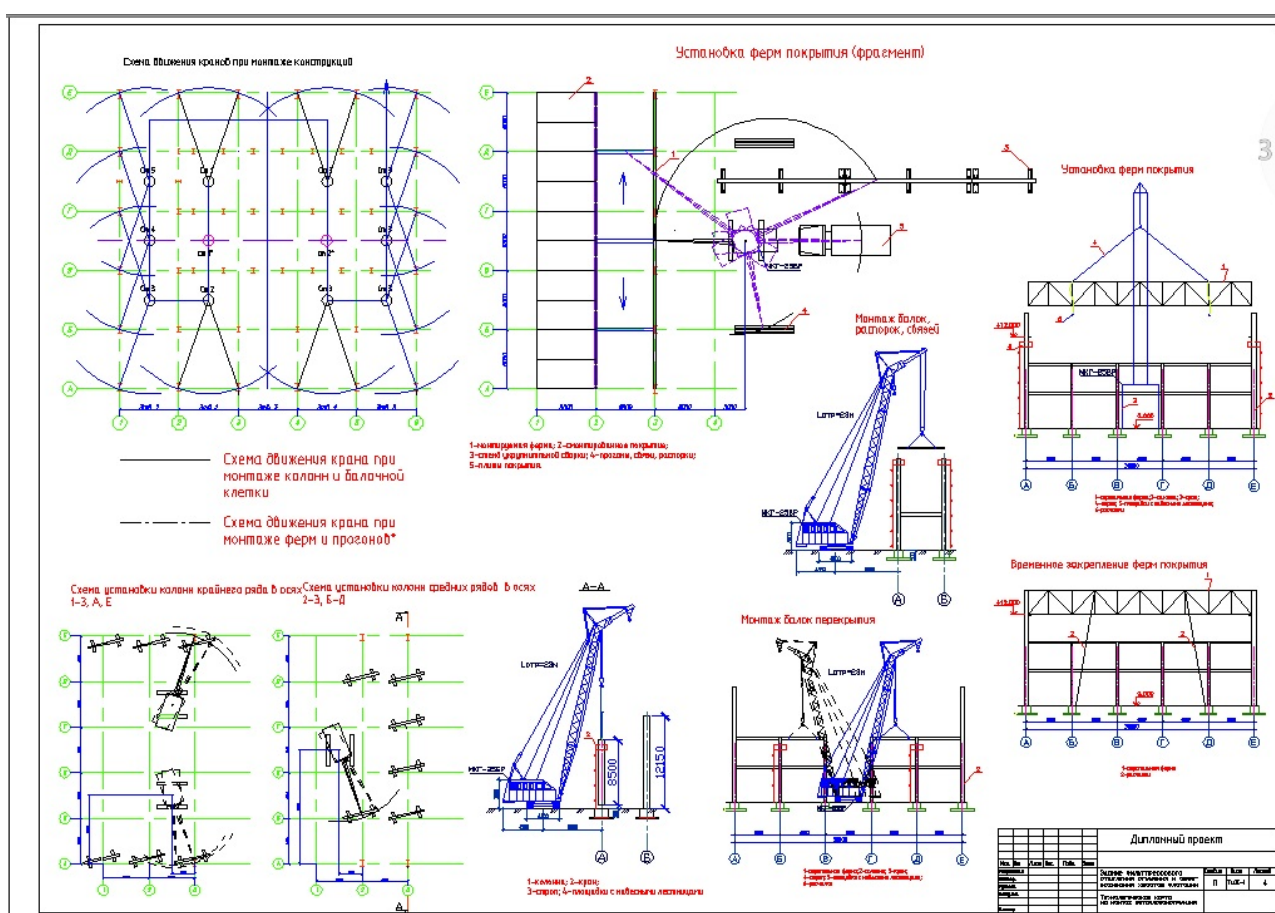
Пример оформления схемы организации работ на монтаж каркаса
